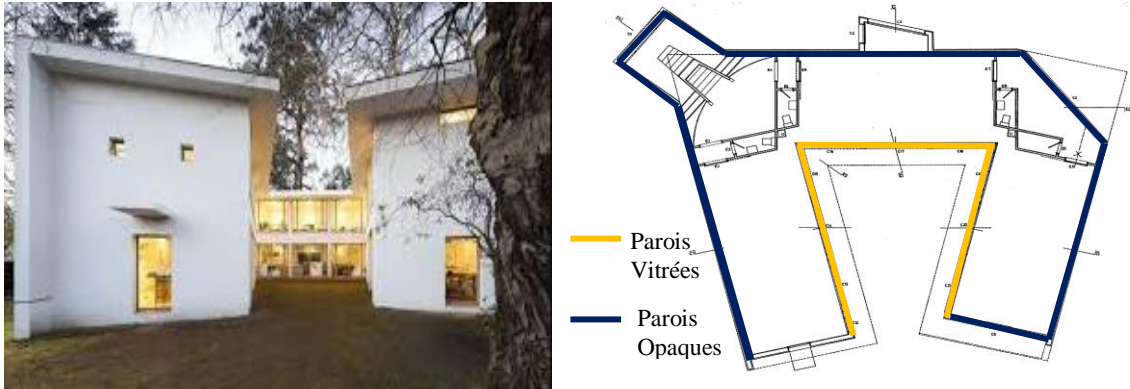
Plan du Pavillon Carlos Ramos.
